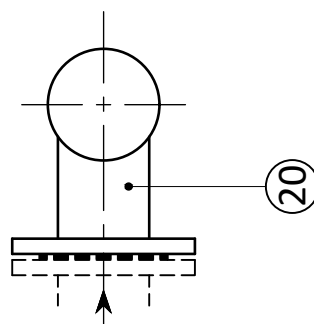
DETAIL B - UITLENGING BOVENGRONDSE BRANDKRAAN MET PE-HD LEIDING
